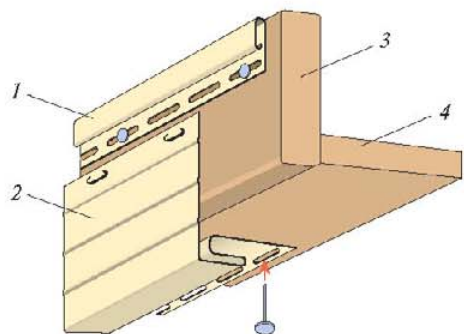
Крепление целой J-фаски к причелине: 1 — финишный профиль; 2 — J-фаска; 3 — причелина; 4 — деревянная обшивка карниза
